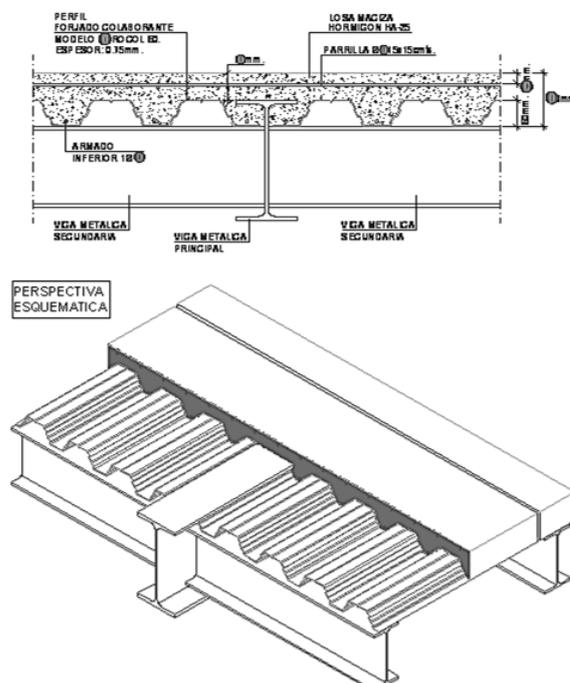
Corte Transversal Armado de Vigas de Alma Llena
